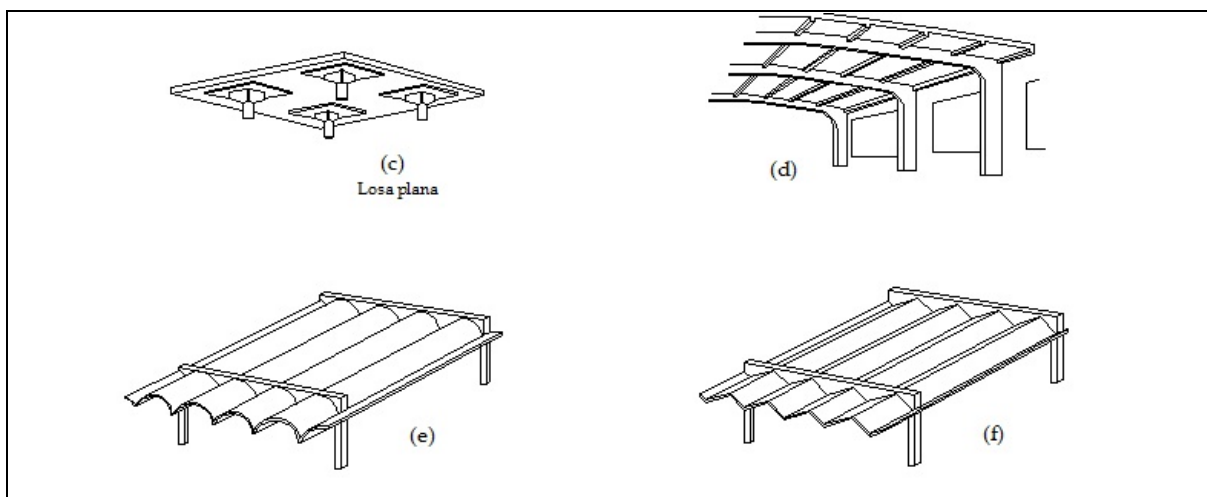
Tipos y formas de estructuras de concreto reforzado.
